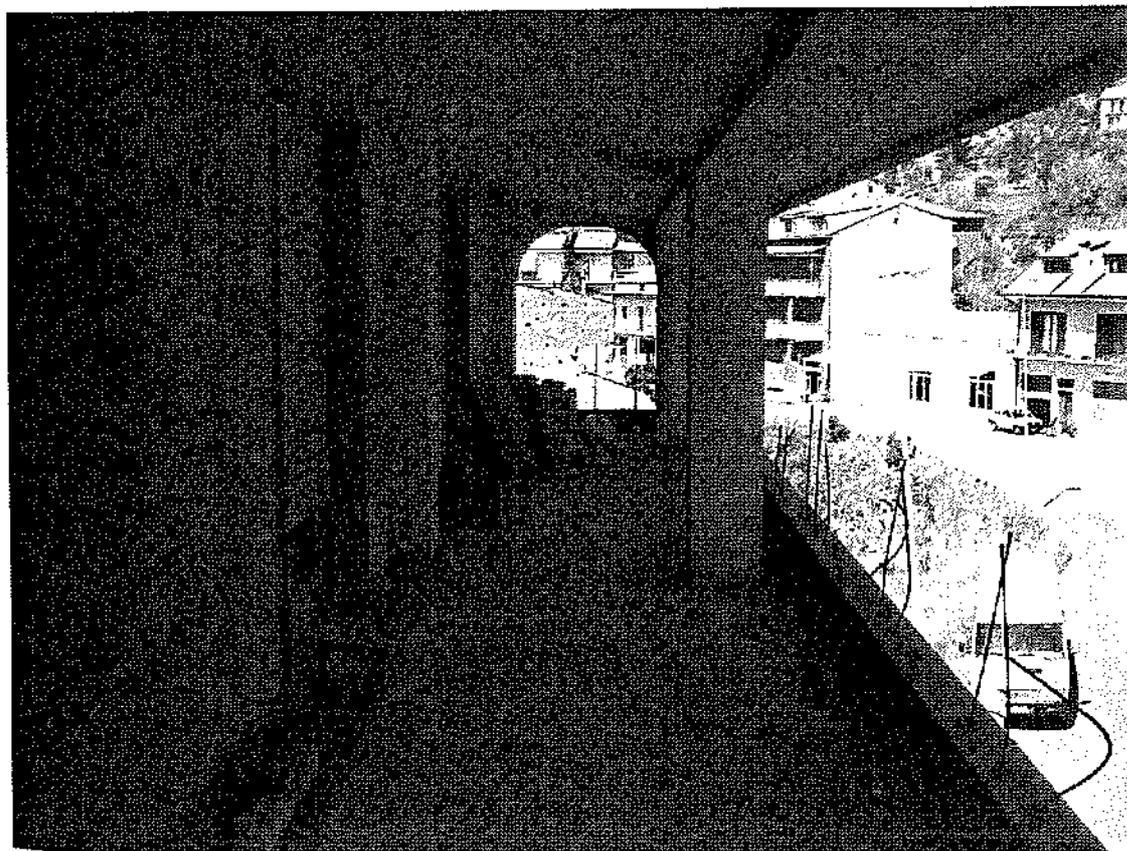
Lotto 5 – Terrazzo (fatto strada) della mansarda ubicata al secondo piano
